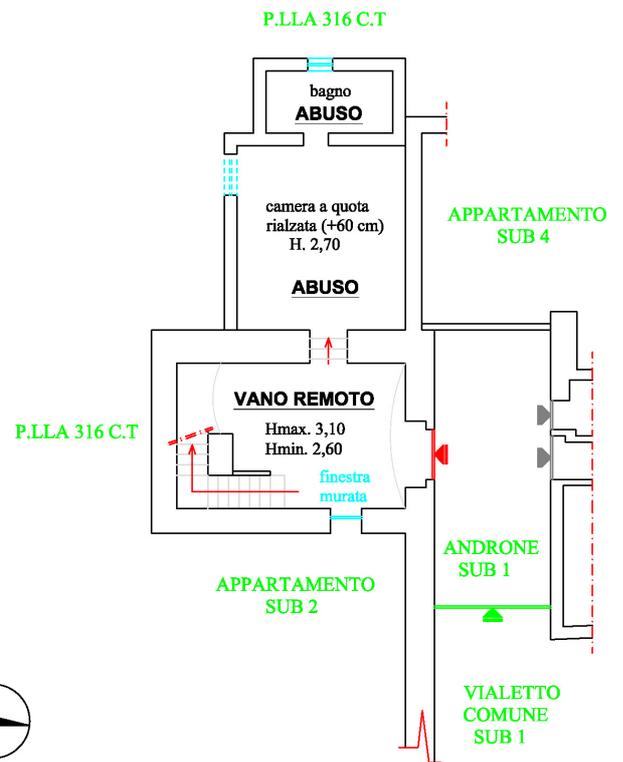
Planimetria stato dei luoghi "sub 3" (fuori scala)
